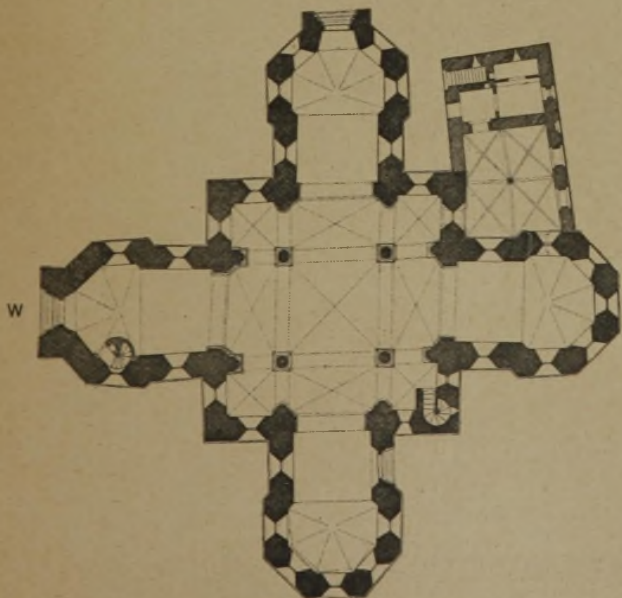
Grundriß Kallundborg-Kirche. (1 : 400.)
